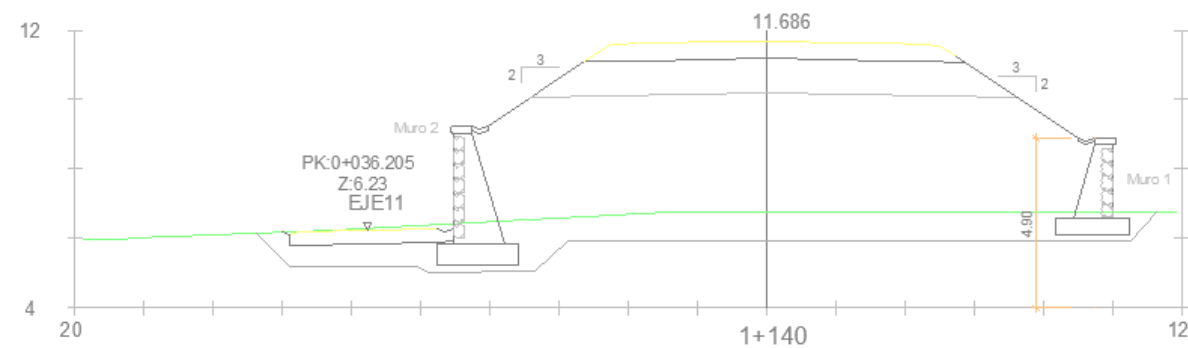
Perfil transversal del vial propuesto, limitado por dos muros de contención.
